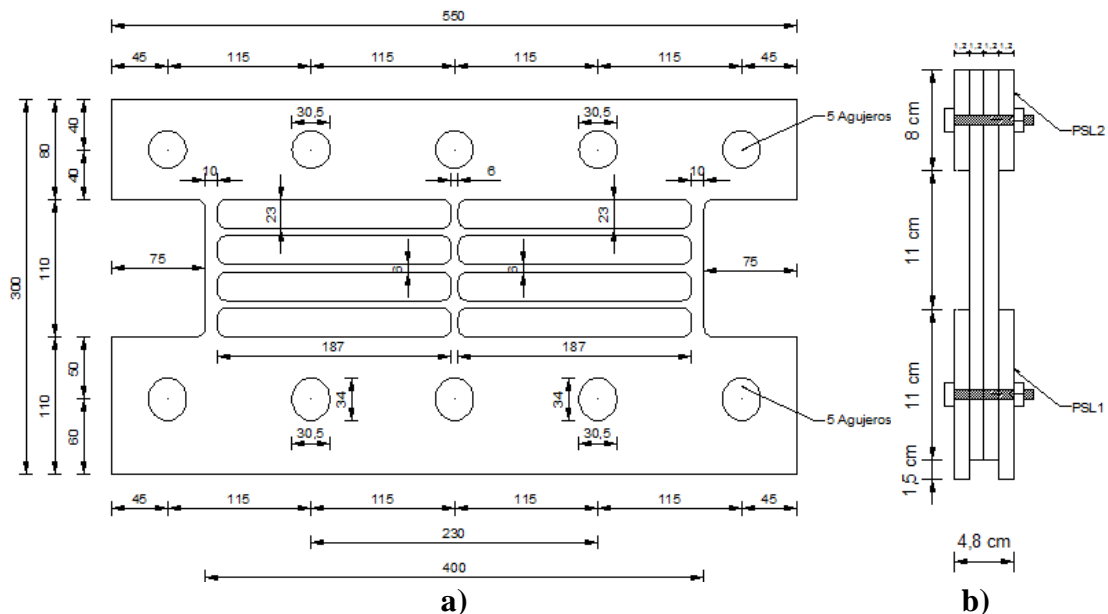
Disipador SLB40_5 a) Vista en planta; b) Vista en Corte.
